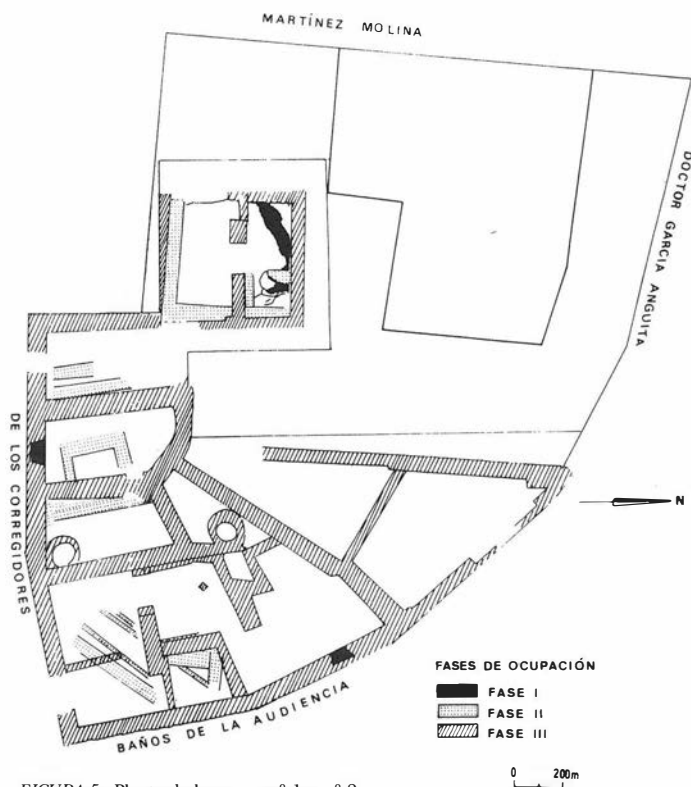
Planta de las casas n.º 1 y n.º 2.
